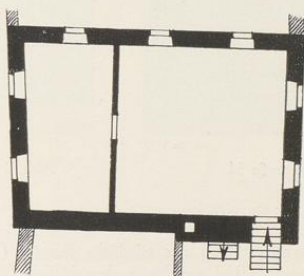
Grundriß des Steinwerks des Hauses Frauenstraße 51. Norden rechts
